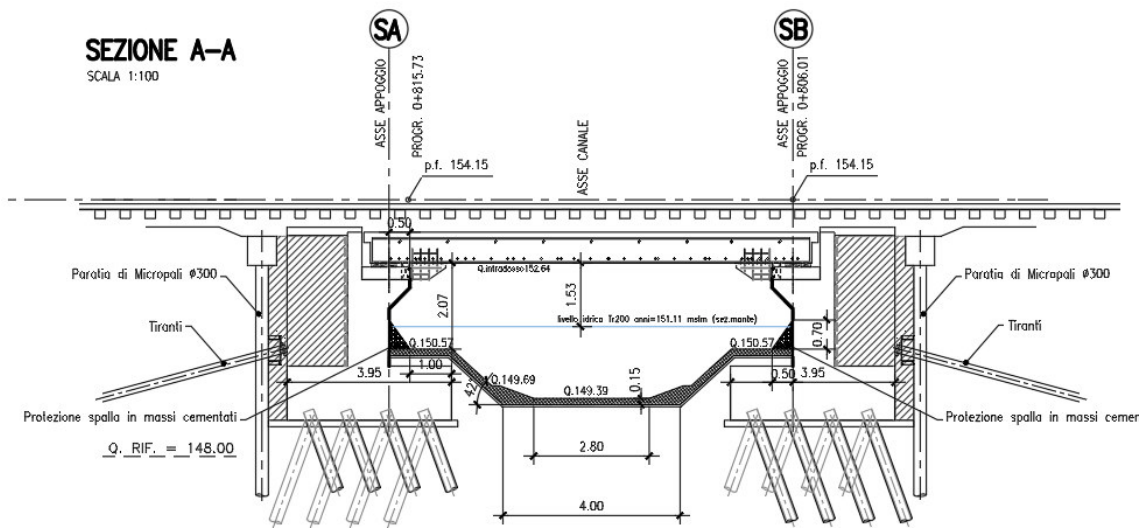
SEZIONE CANALE DI PROGETTO IN CORRISPONDENZA DEL NUOVO PONTE
